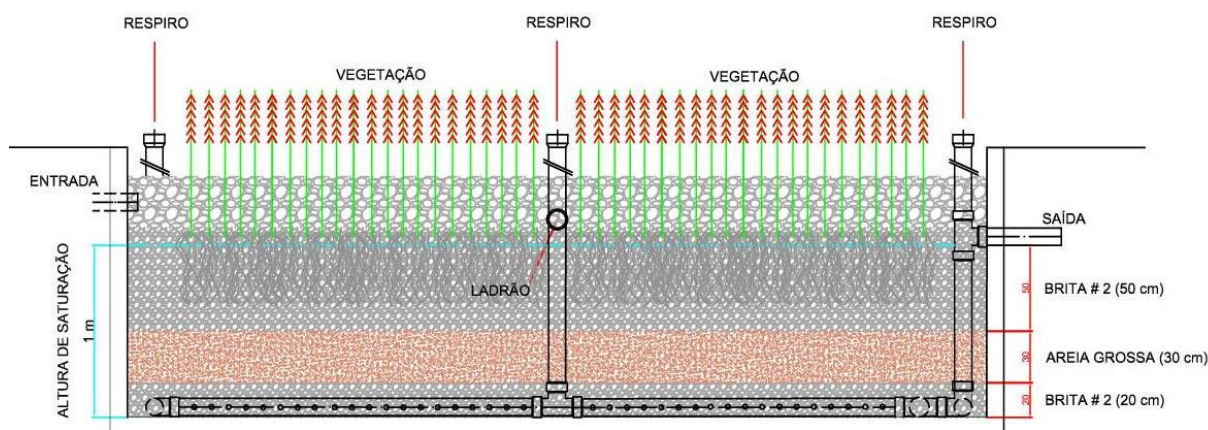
Croqui do *wetland* construído de fluxo vertical afogado
